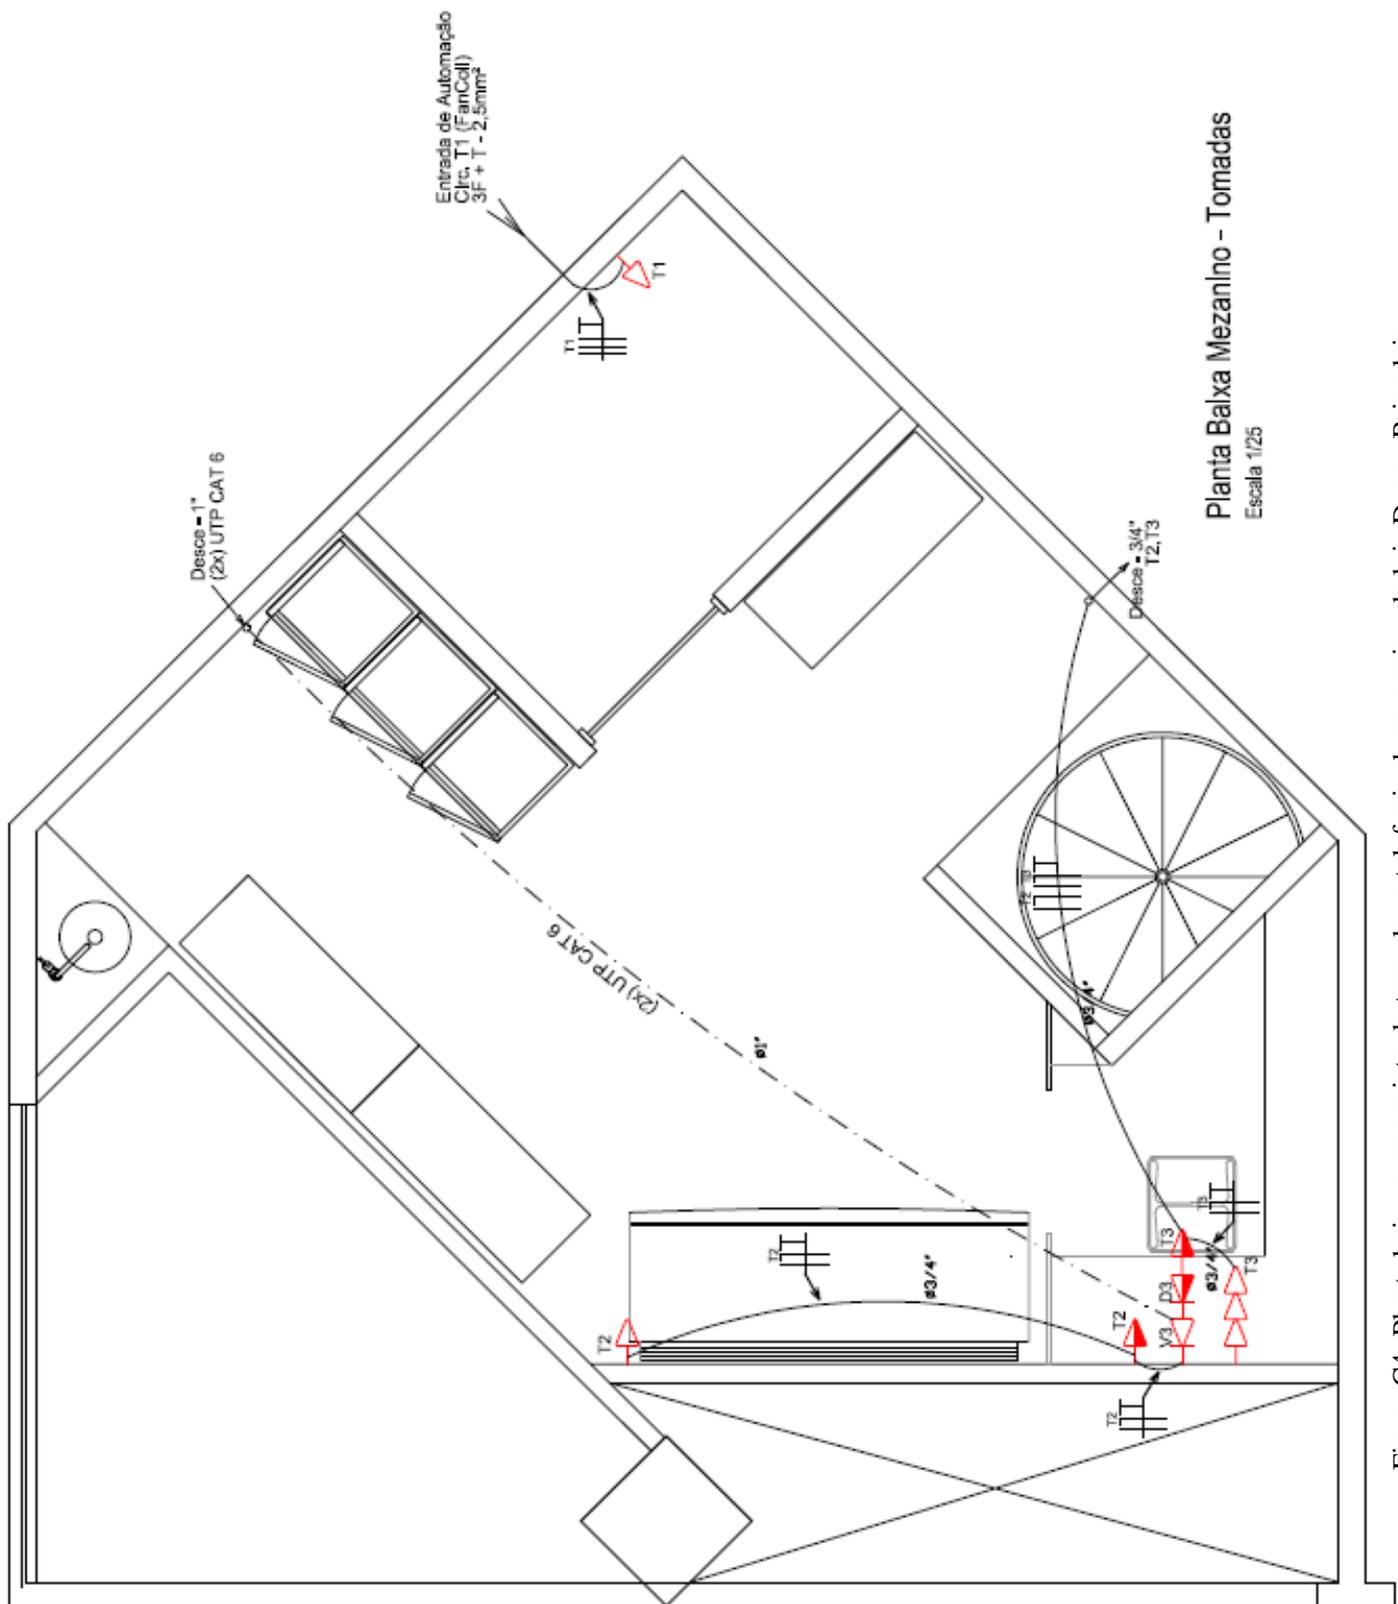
Planta baixa com projeto de tomadas e telefonia do mezanino da loja Donna Brigadeiro
